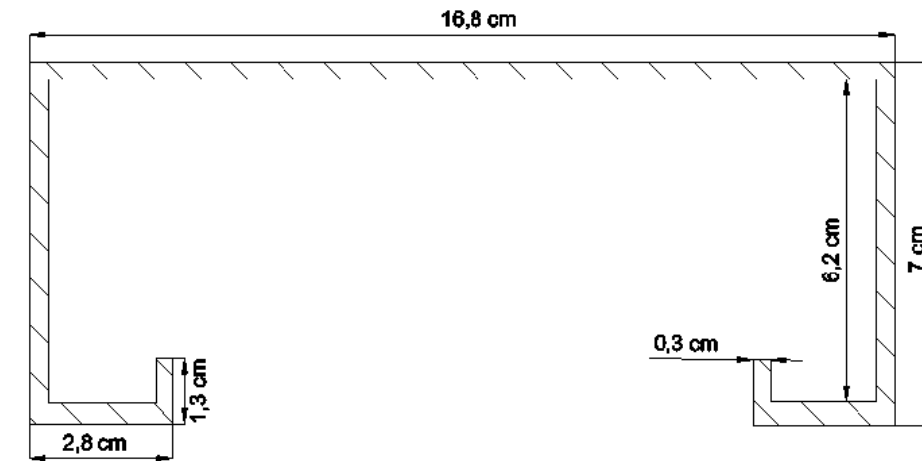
Schéma de la section d'un profil métallique d'un pieu battu
